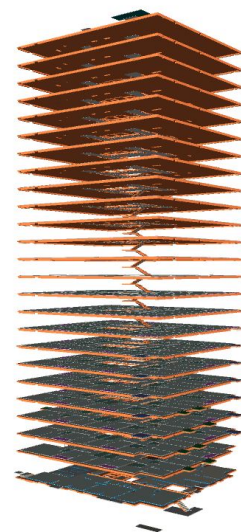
Система внутренних перекрытий зданий и сооружений
